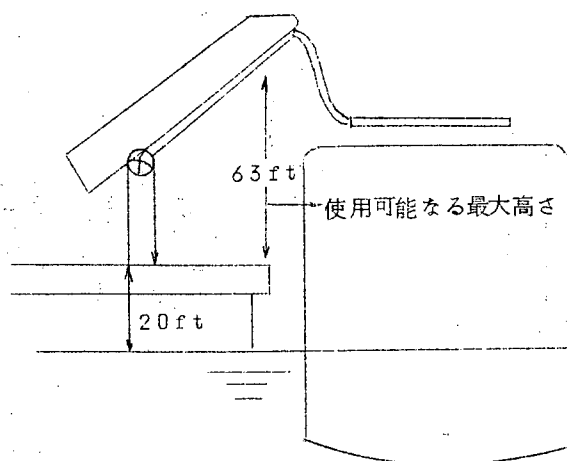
at NORTH PIER 90000D.W.T. 型係留図
